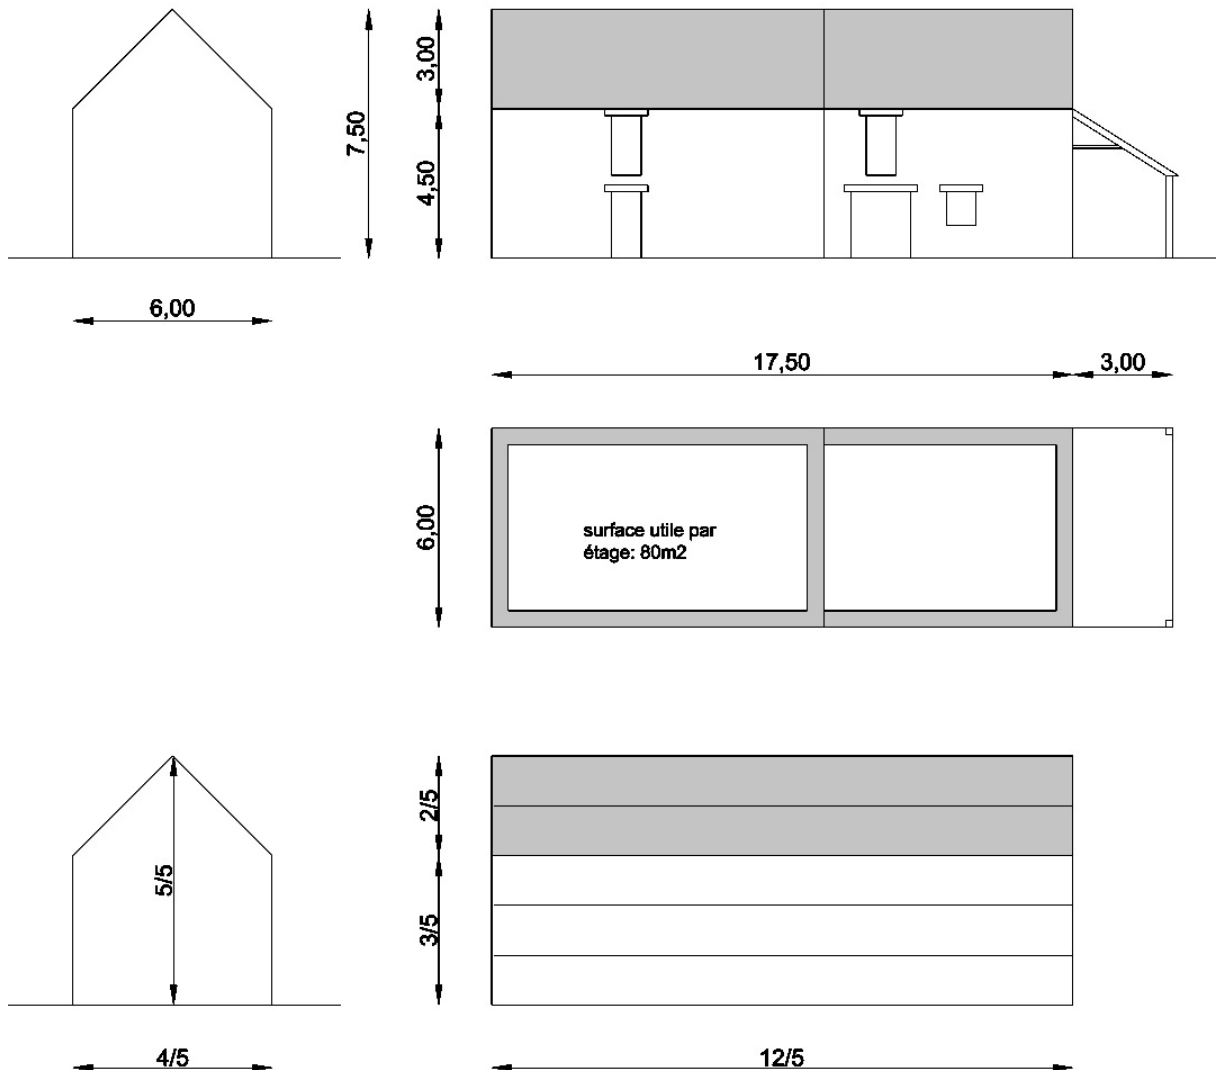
plan de coupe des constructions « néo-bretonnes » en hameau.
